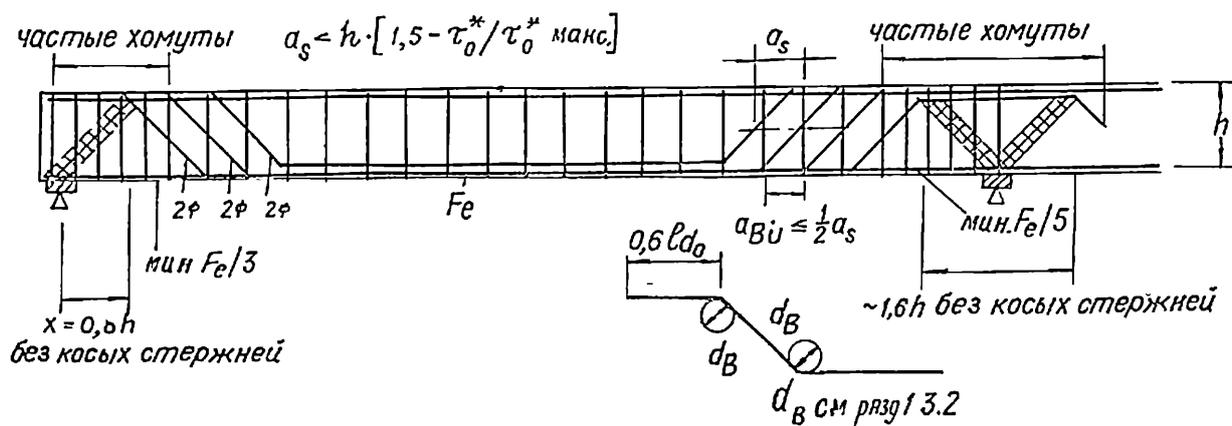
8. Армирование отогнутыми стержнями
